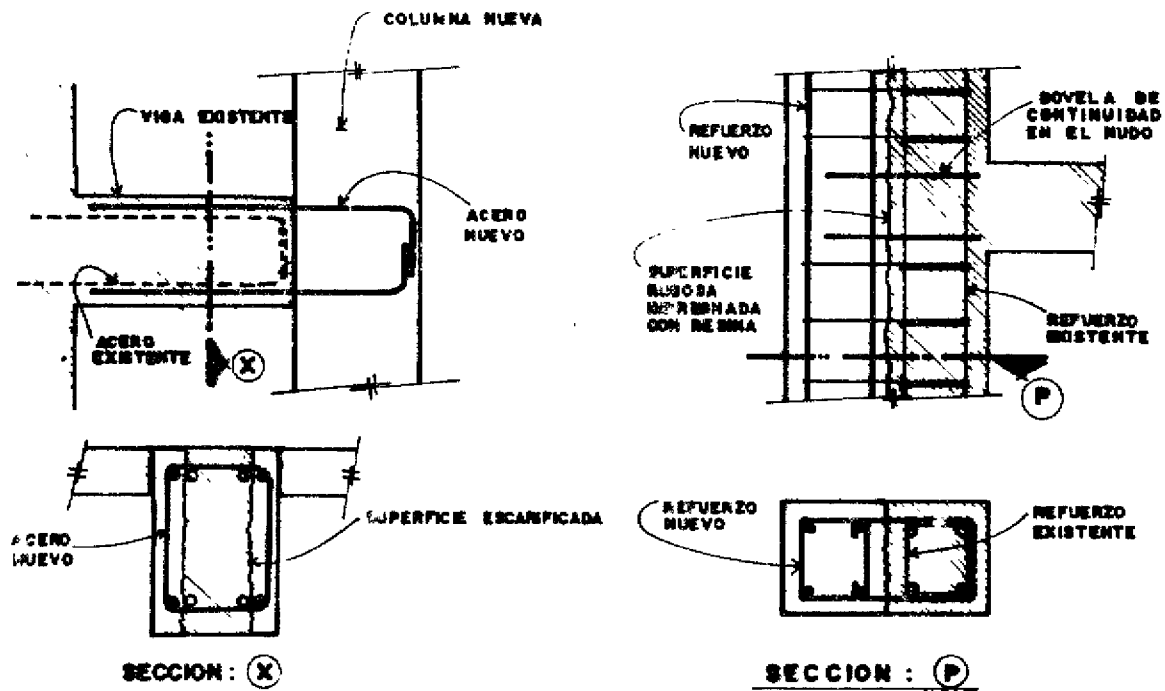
VIGA EXISTENTE CON COLUMNA NUEVA
